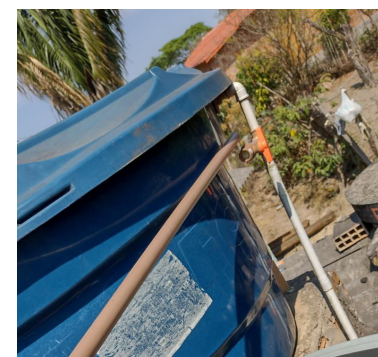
Interligação da água da rua. (Fonte: acervo Contraponto)
